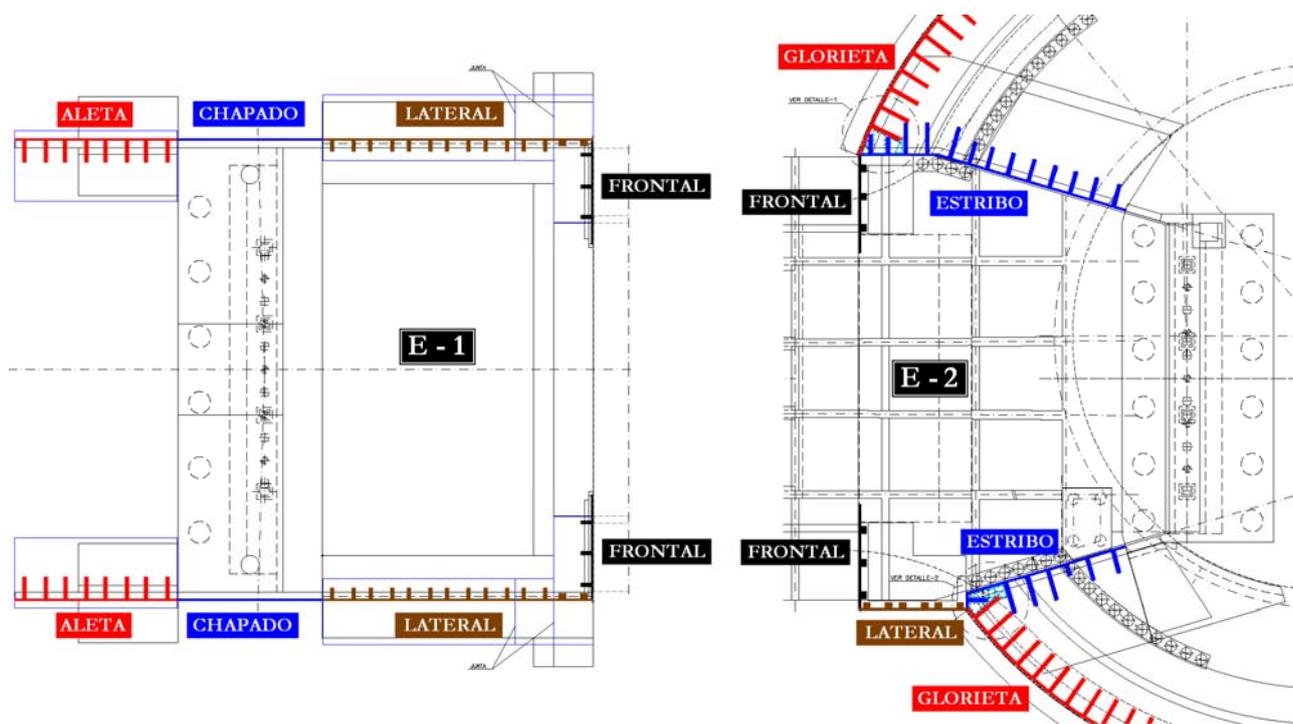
Muros prefabricados en los estribos del puente singular de Valdebebas sobre la M-12
